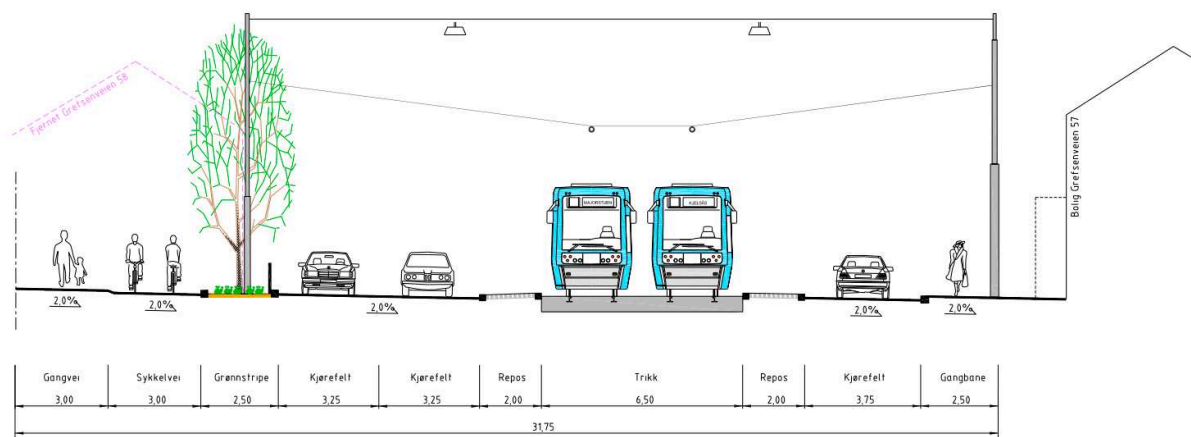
Snitt 1. Viser løsningsalternativ på Storo bro, sett fra byen mot Grefsen. Mulighet for takoverbygg illustrert.
